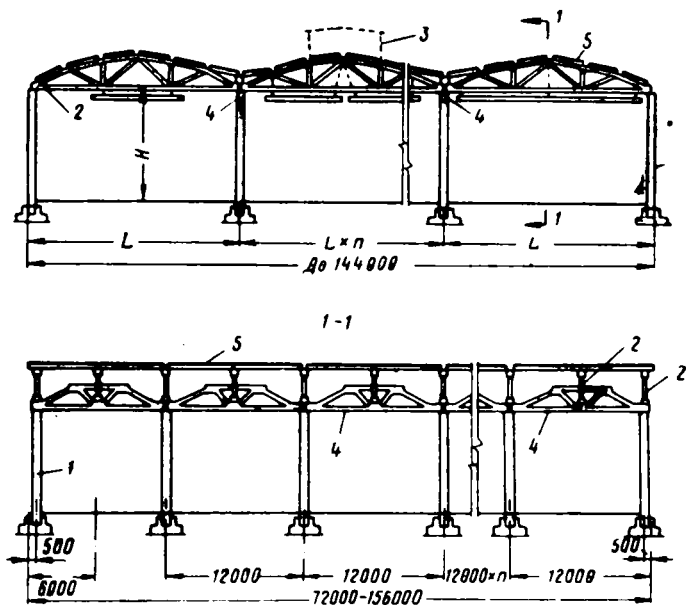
Конструктивная схема IV покрытия зданий со скатной кровлей при шаге колонн среднего ряда 12 м и шаге стропильных ферм 6 м
